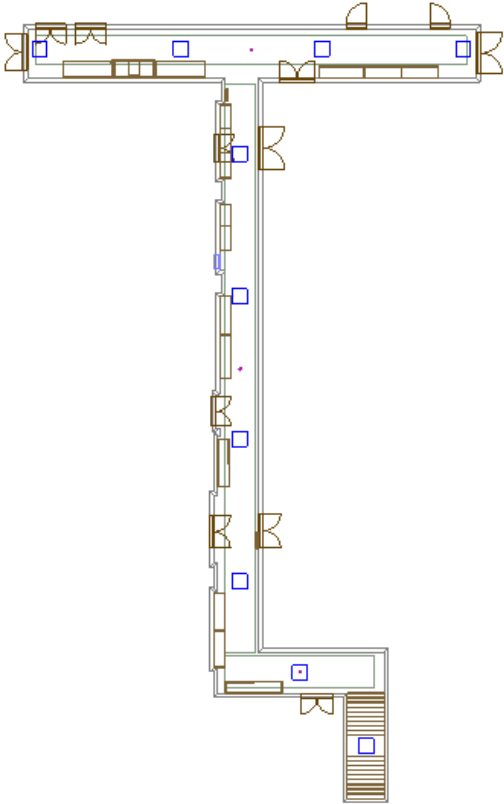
4: Corridoio (Area 5 e Area 6/8) – Planimetria
